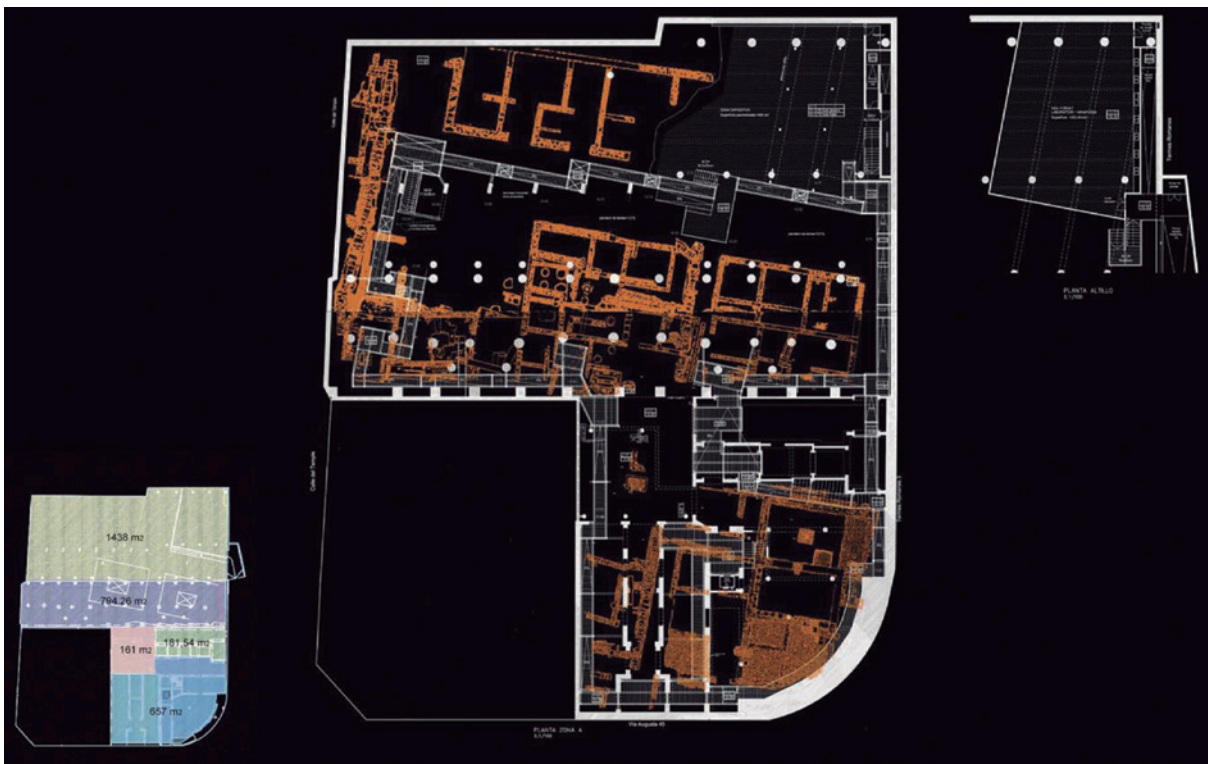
Planimetría del proyecto de conexión del espacio de las Termas y el *Decumanus*. Imagen: Museo de Badalona.
